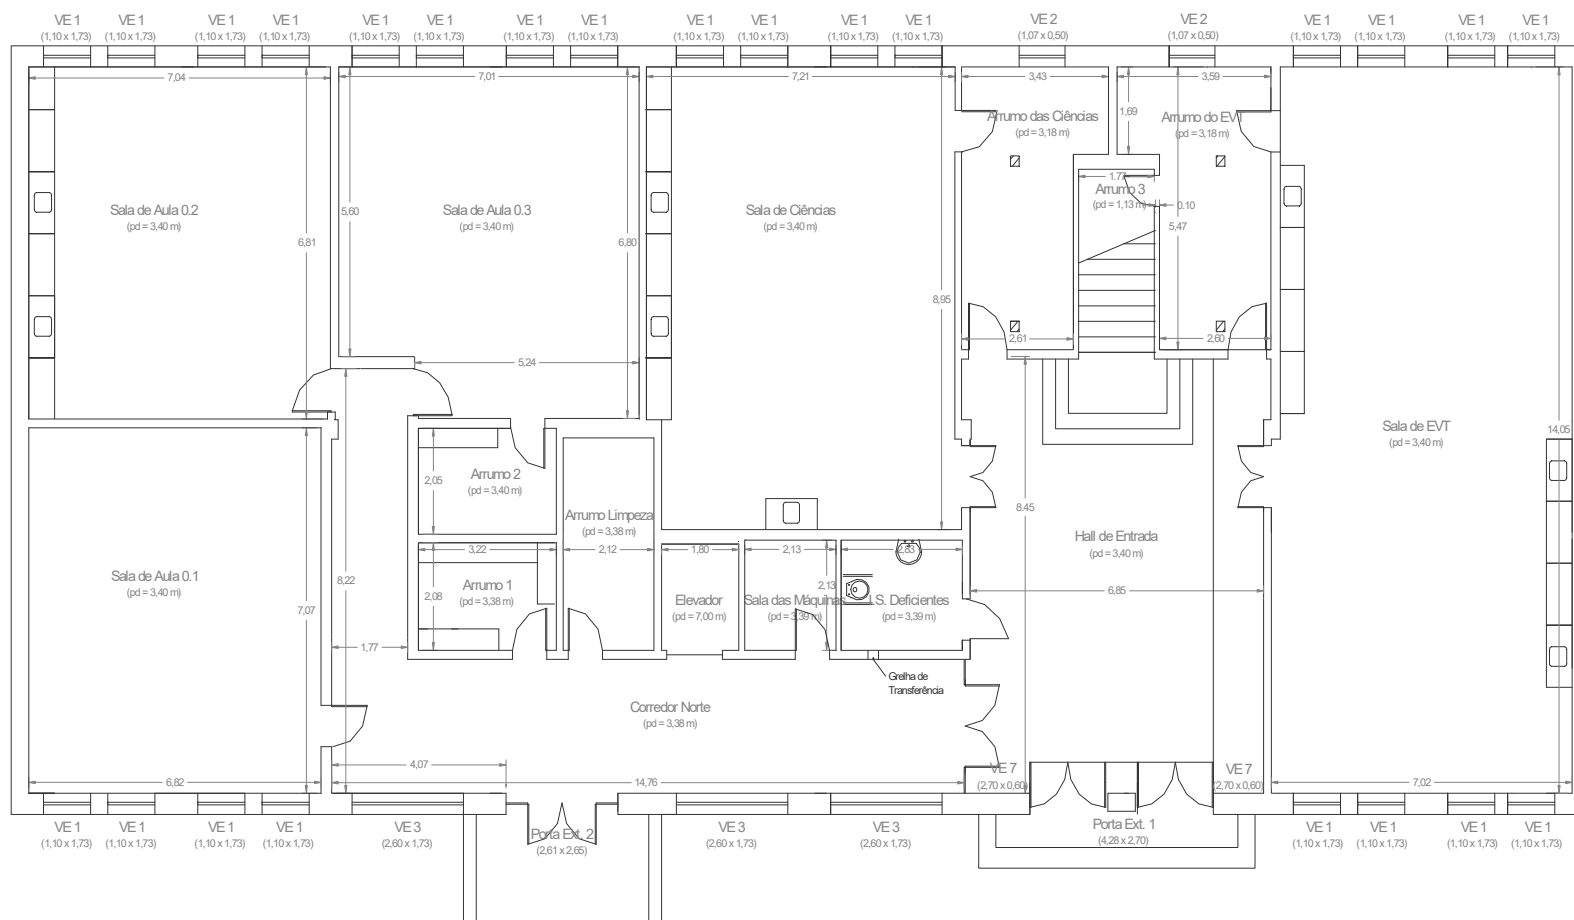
Desenho 2D do levantamento dimensional e geométrico do Piso 0 do Bloco C.
